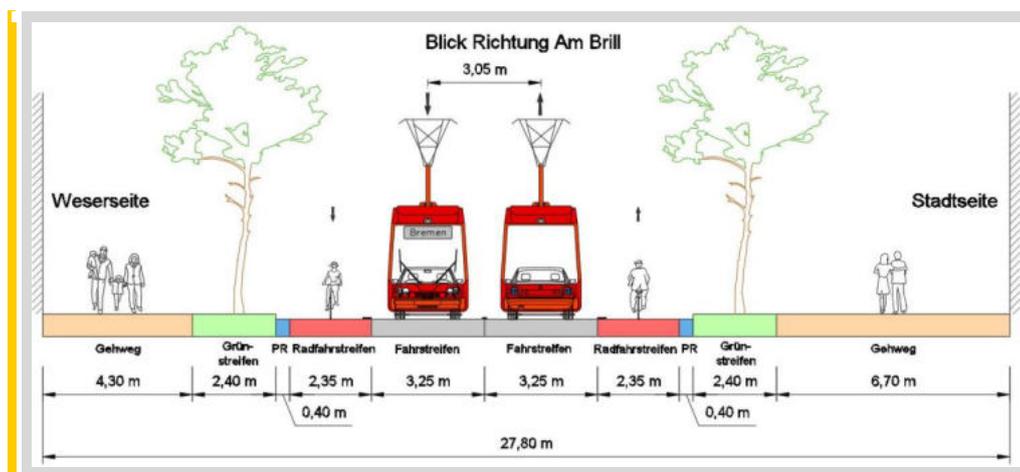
RQ 2 Planfall straßenbündiger Bahnkörper
